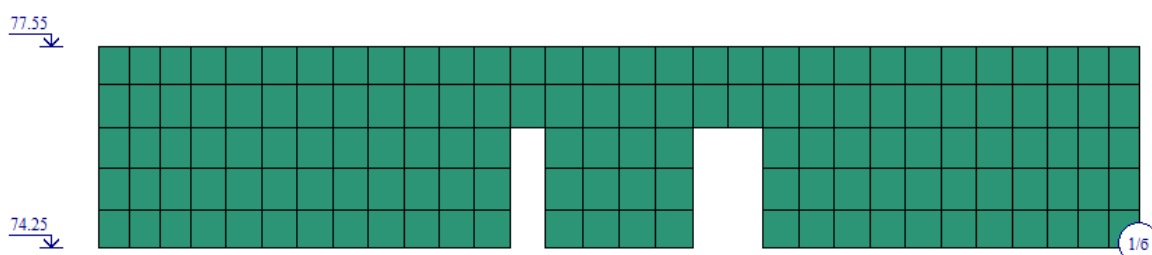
Монолитная стена здания по оси 1/б на отм. 74.25 м
